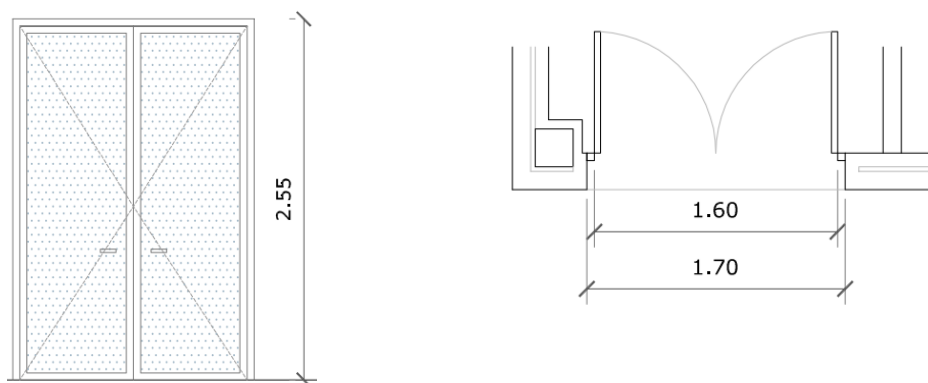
y Figura 5.12 Esquema puerta y geometría de apertura
